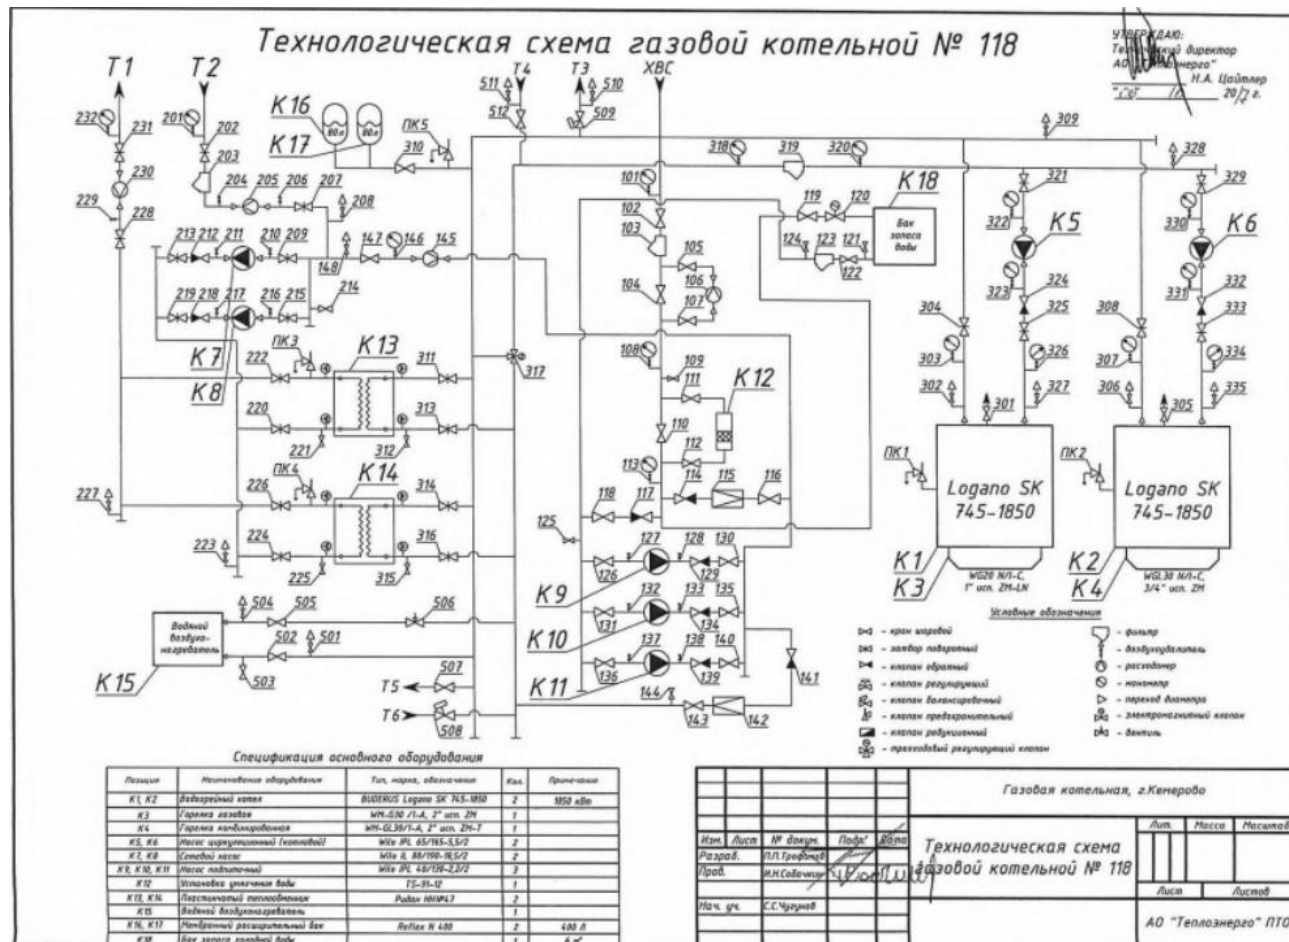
Тепловая схема Котельной № 118
